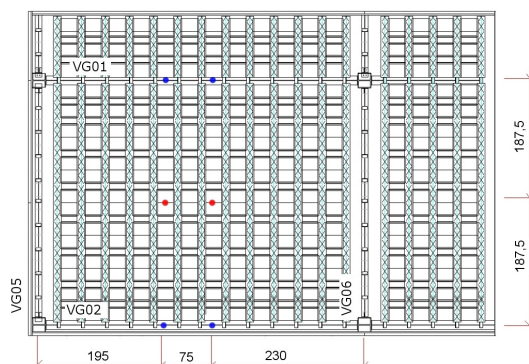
Esquema de carregamento e vista da estrutura - 8ª etapa de carregamento concentrado
